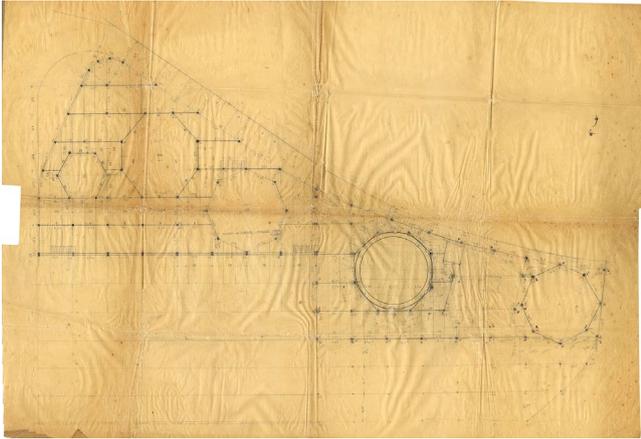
Plano de estructura Zonas C y D. [ANCO 1940-1942]
